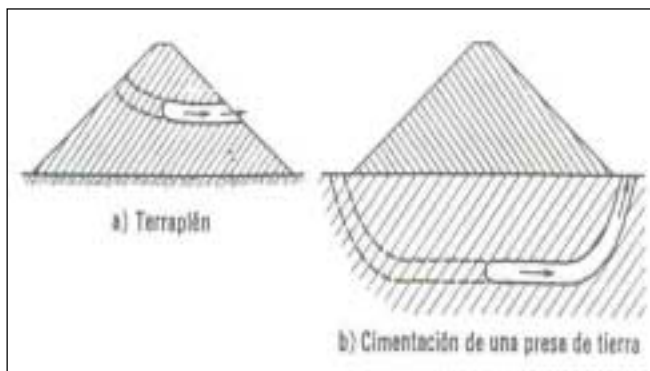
Proceso de erosión regresiva que conduce a la tubificación.
